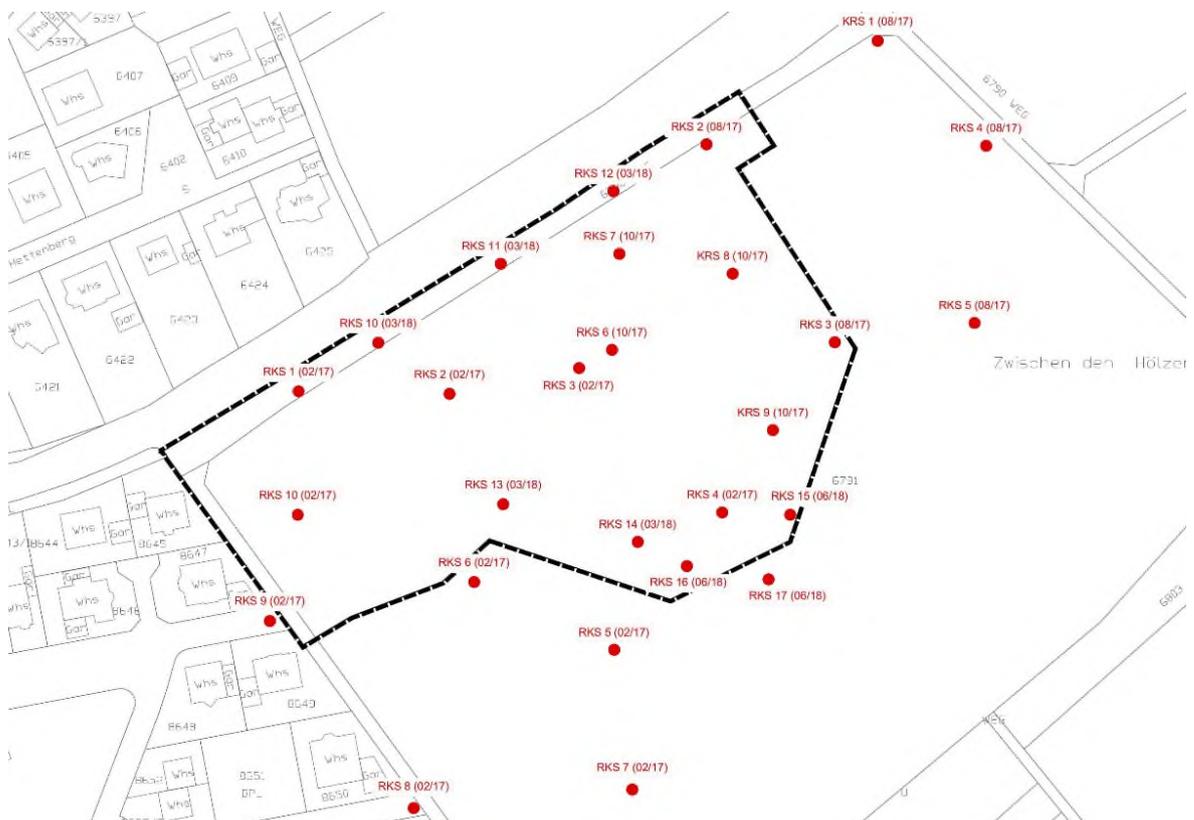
Übersicht der durchgeführten Rammkernsondierungen
